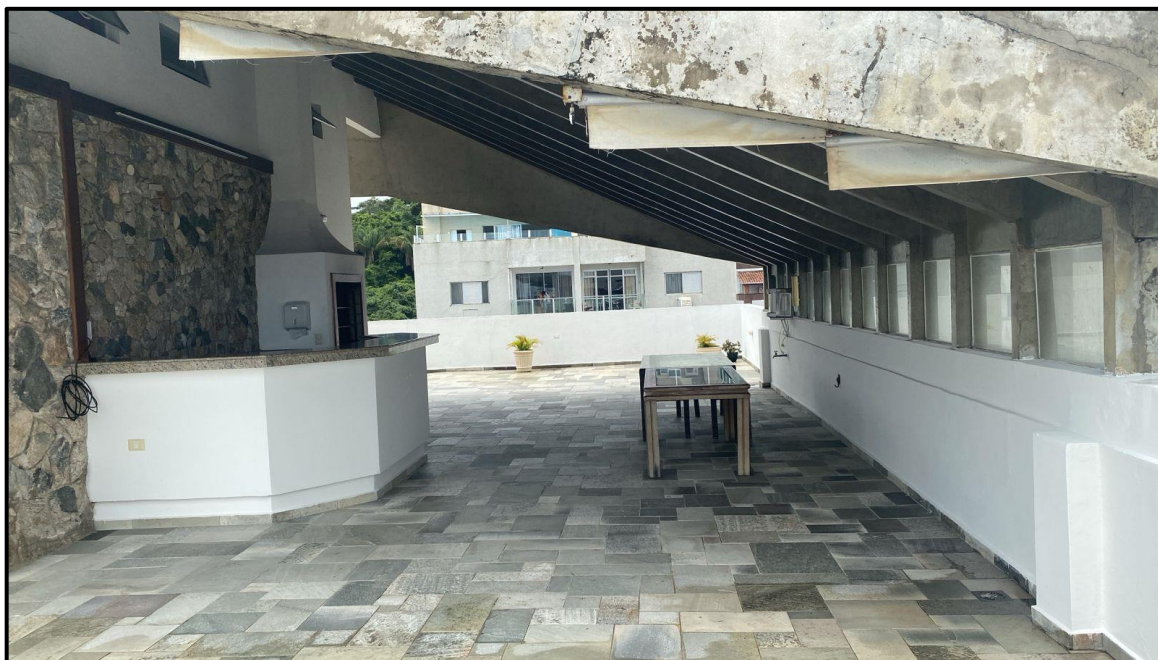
Área comum do condomínio – Churrasqueira situado no último pavimento
